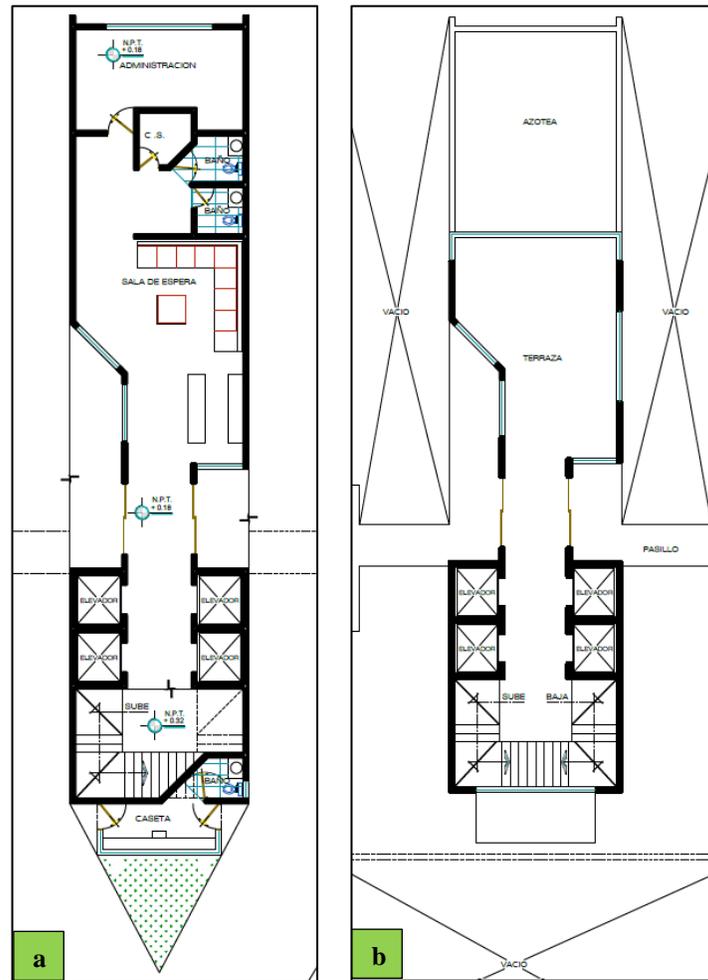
Detalle arquitectónico de distribución de elementos de áreas de uso común del proyecto; a) planta baja; b) planta alta.
